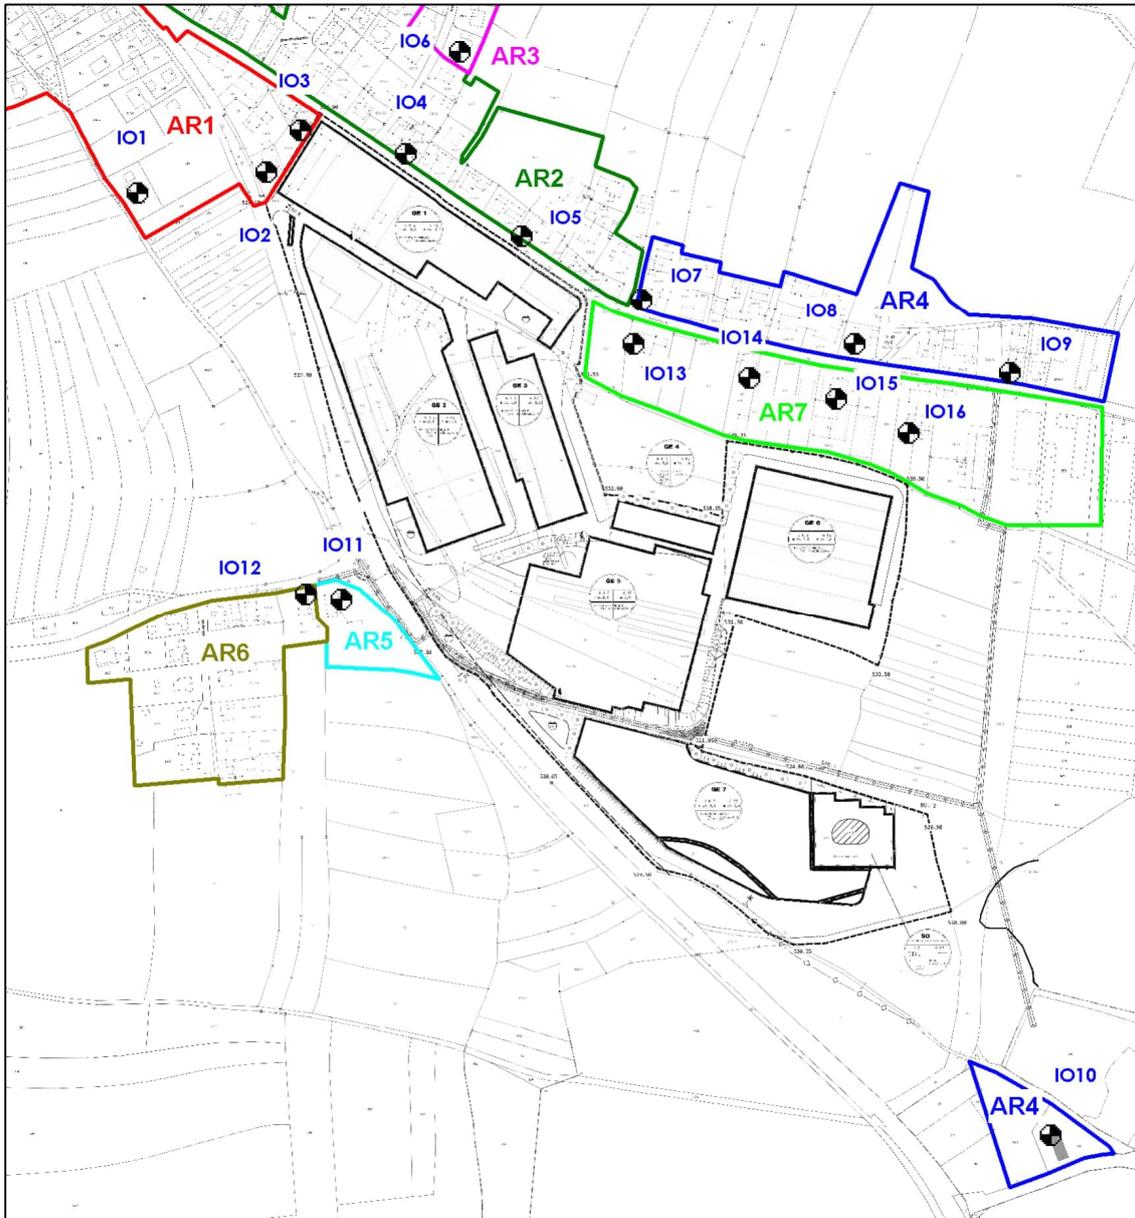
Lageplan mit Darstellung der verschiedenen Abstrahlrichtungen
